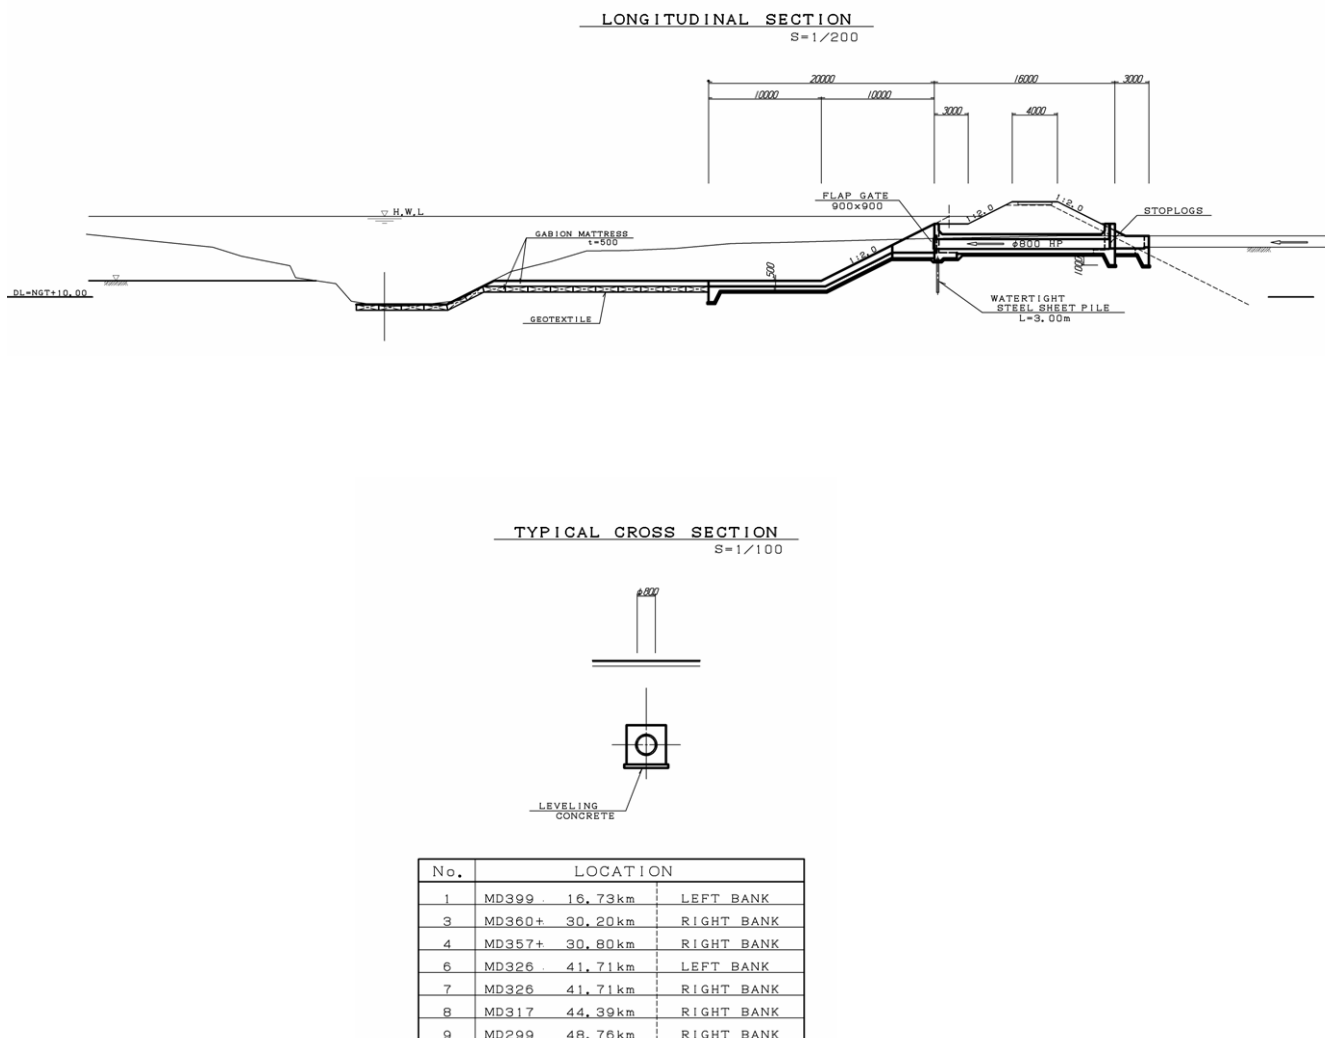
改築する樋管一般構造図 (φ 800 断面)
